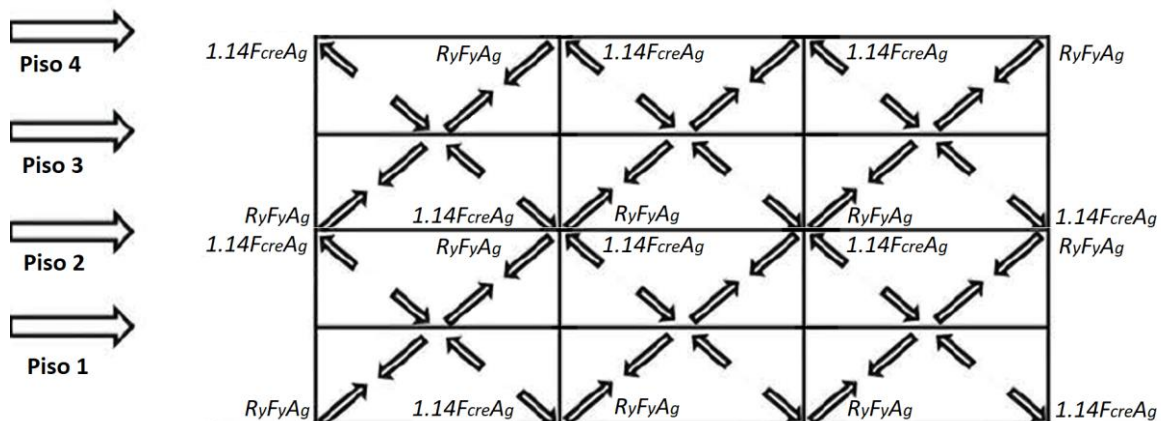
Distribución de las fuerzas de las riostras a vigas y columnas para la Condición 1
